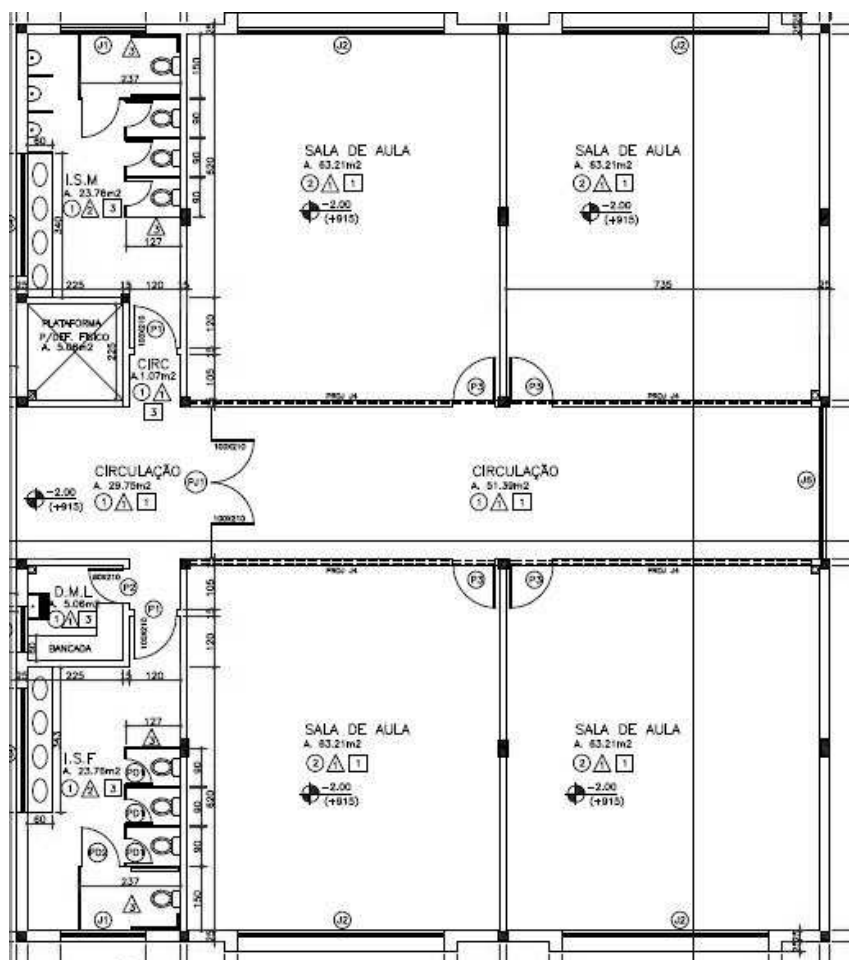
PLANTA BAIXA DA OBRA 3
